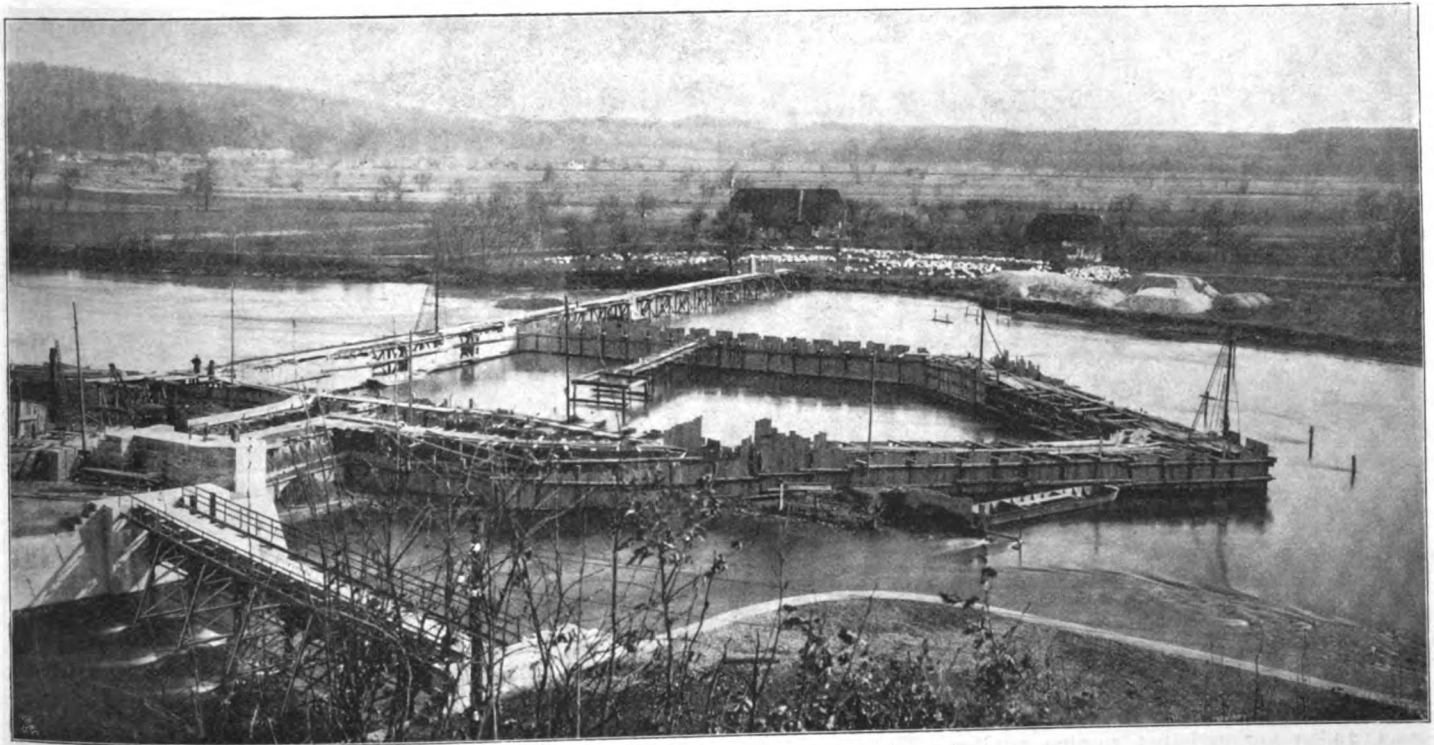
Bau des Wehres mit trocken gelegten Baugruben.
